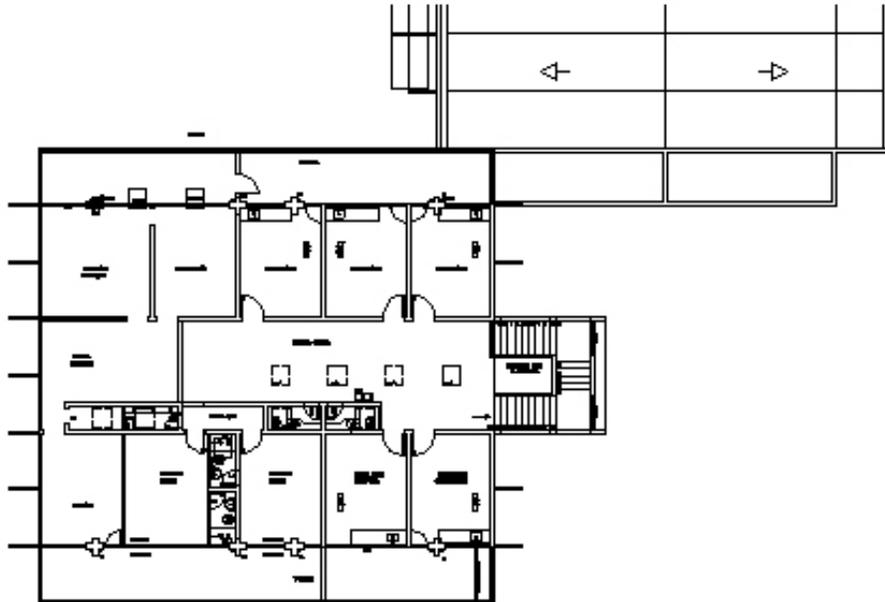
Planta do segundo pavimento da clínica P.S.
